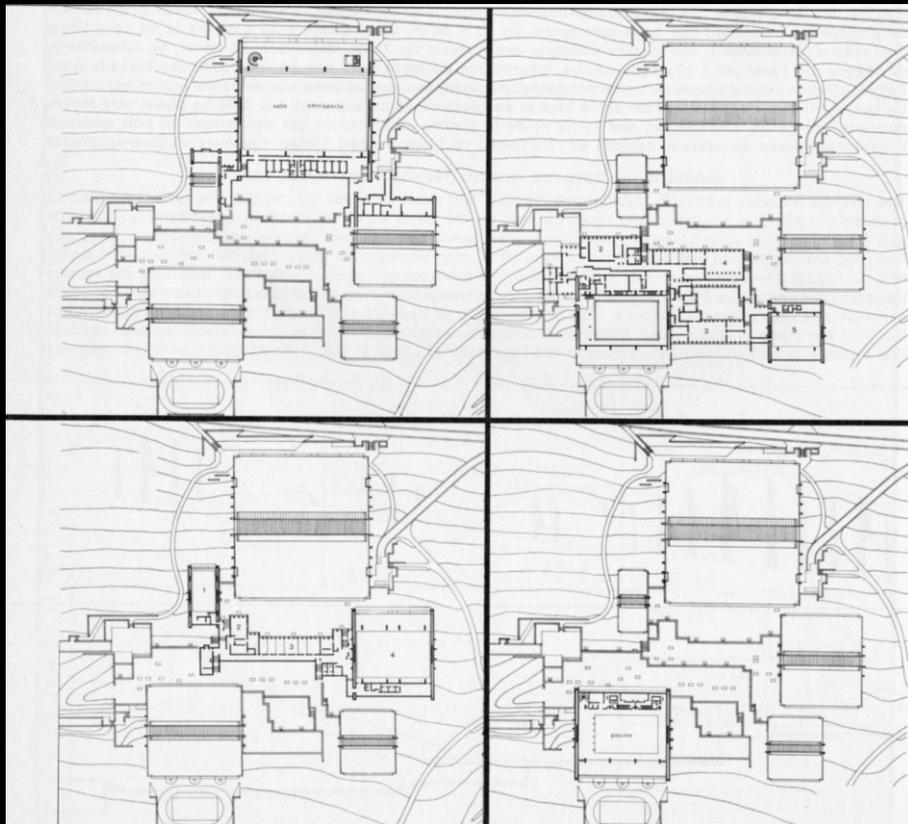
Plan d'étages de l'Institut d'Éducation Physique. ©FondationVandenhove.be
